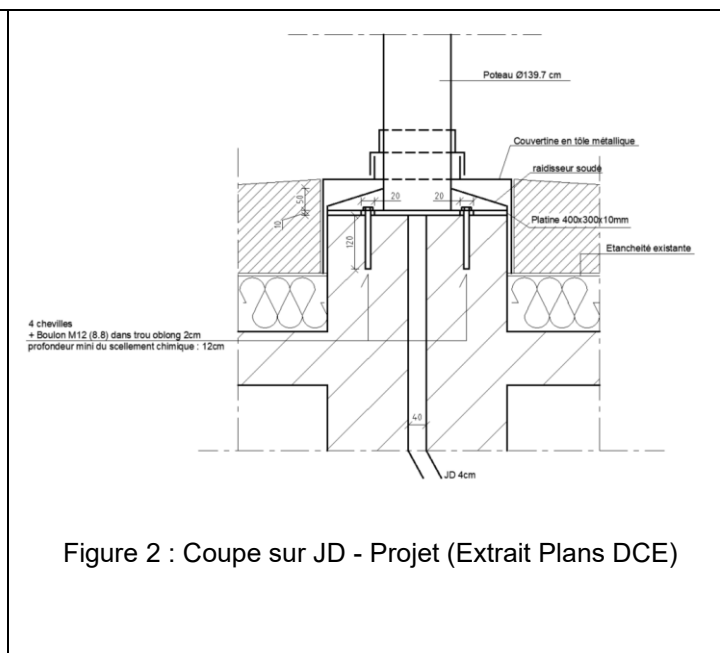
Coupe sur JD - Projet (Extrait Plans DCE)
